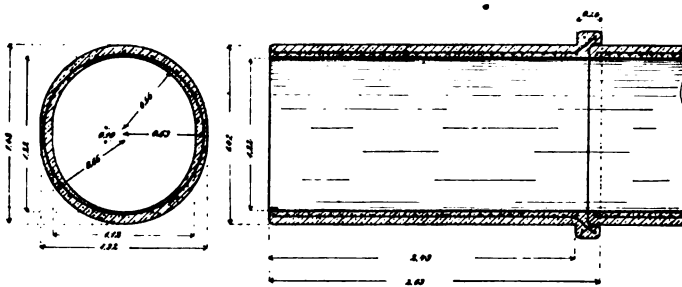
Eisenbetonrohre mit Muffen. 1:40.
